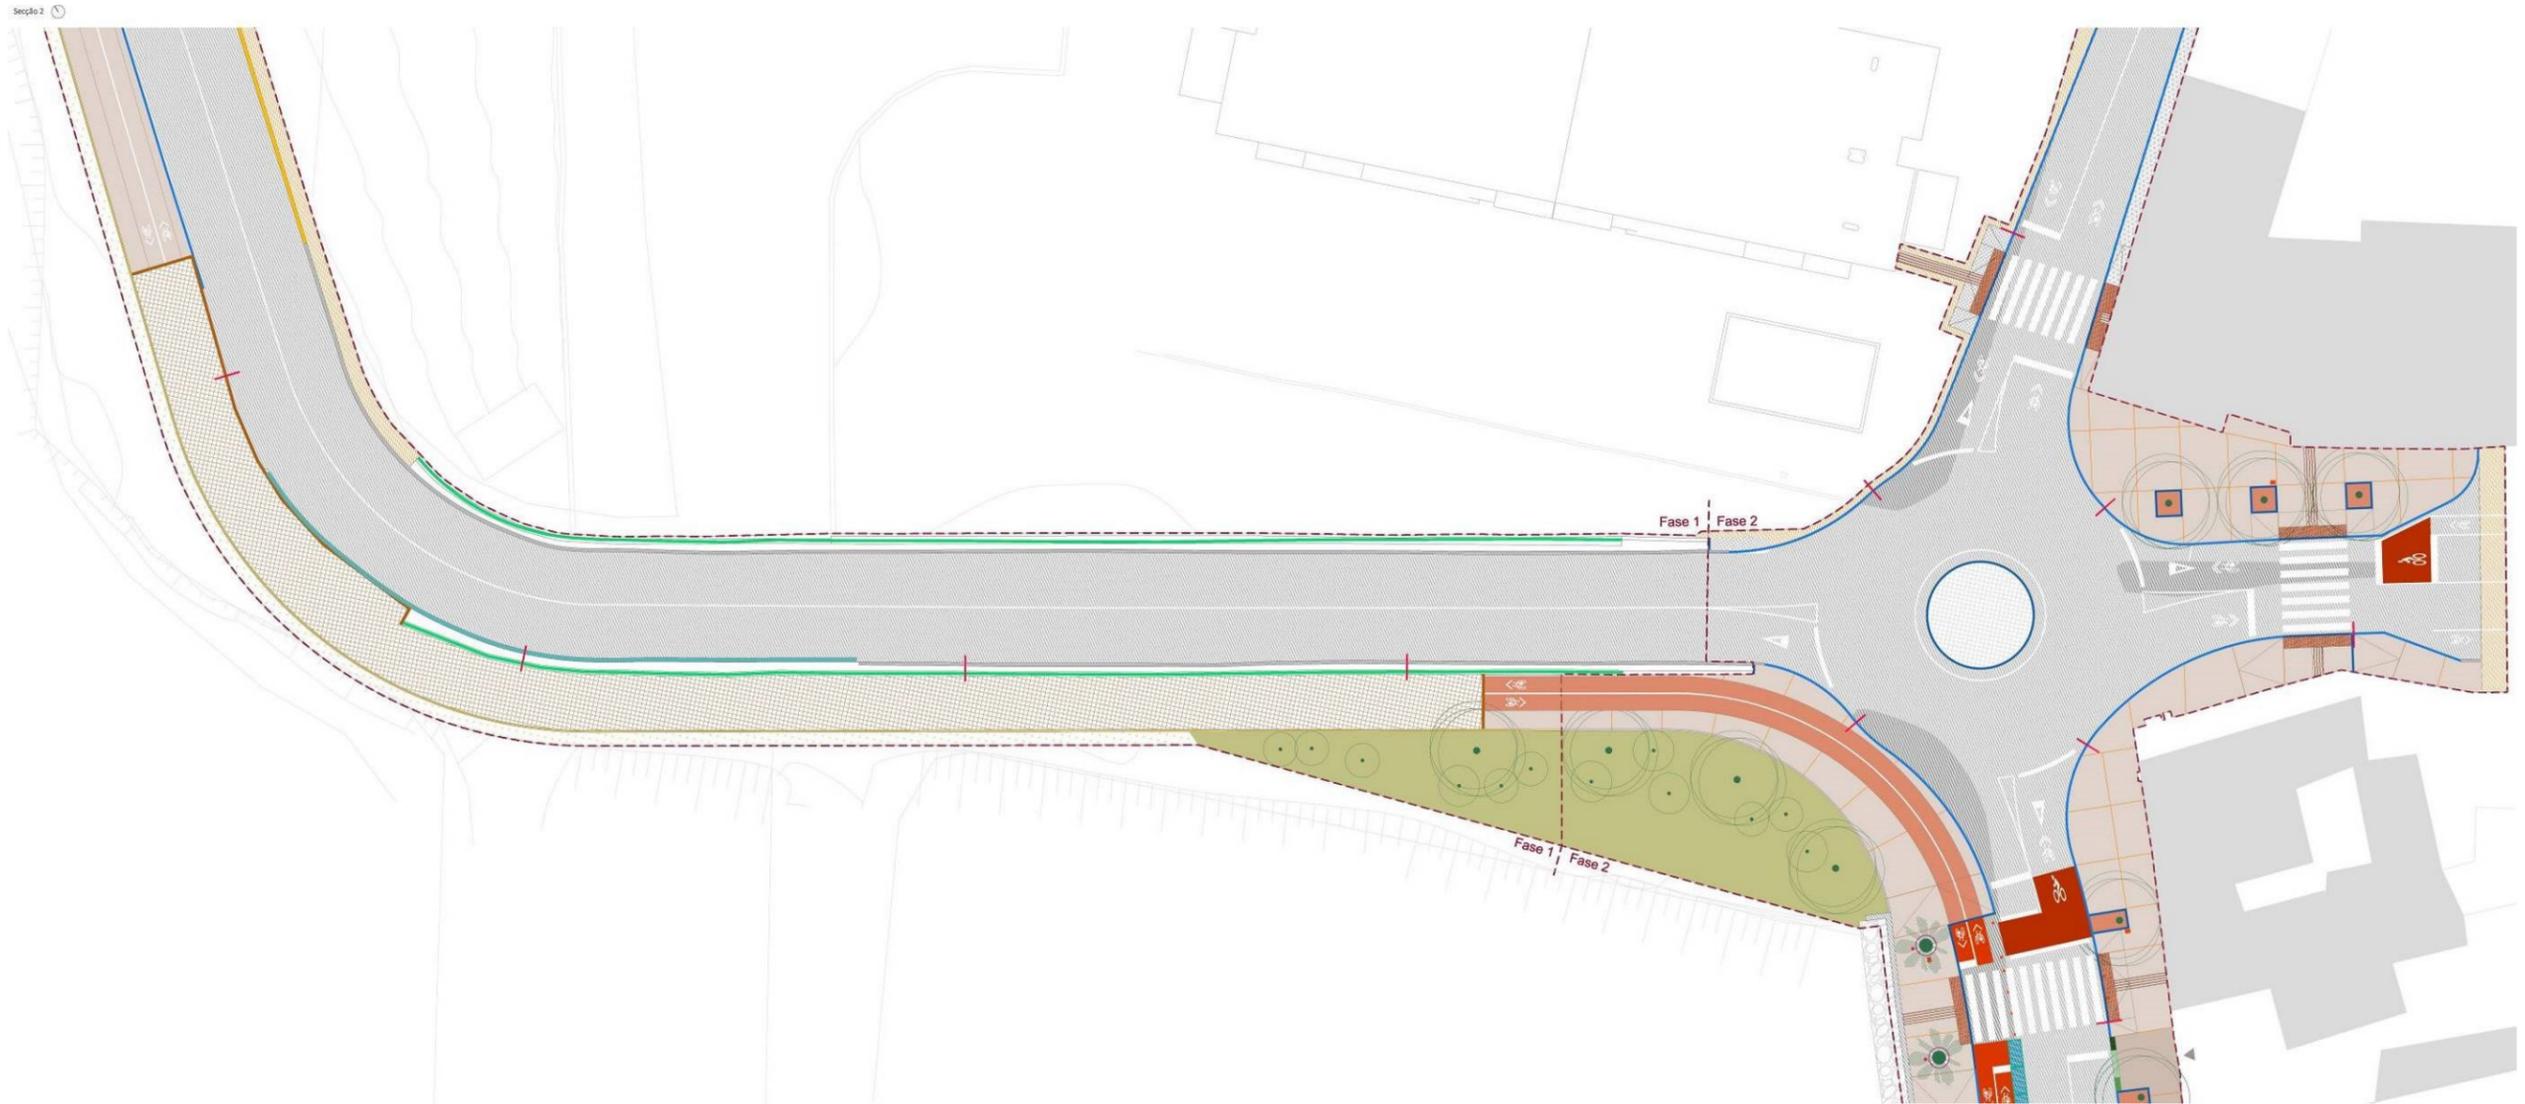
Plano Geral de Intervenção - secções 1 e 2
